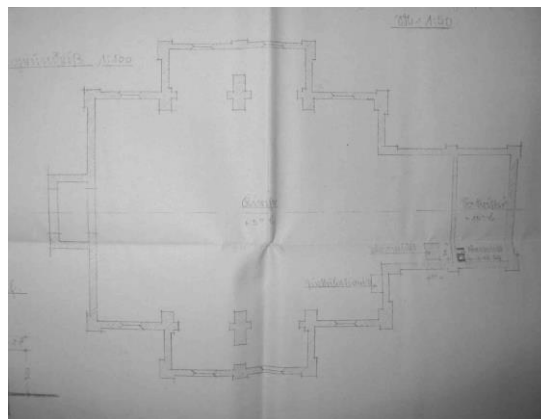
Einbau einer Warmluftheizung 1937, Architekt Heinrich Brenker
